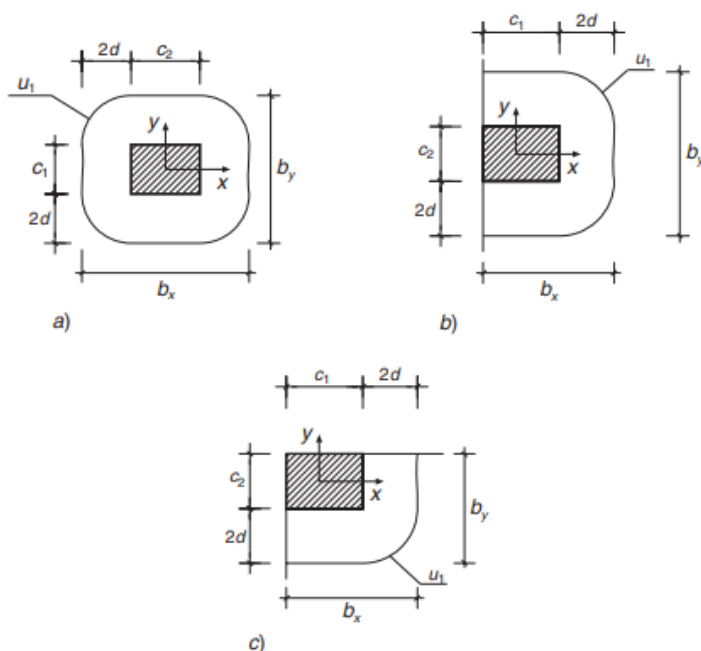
Determinación del perímetro crítico según posición de pilar (Instrucción de Hormigón Estructural (EHE-08), 2008)
